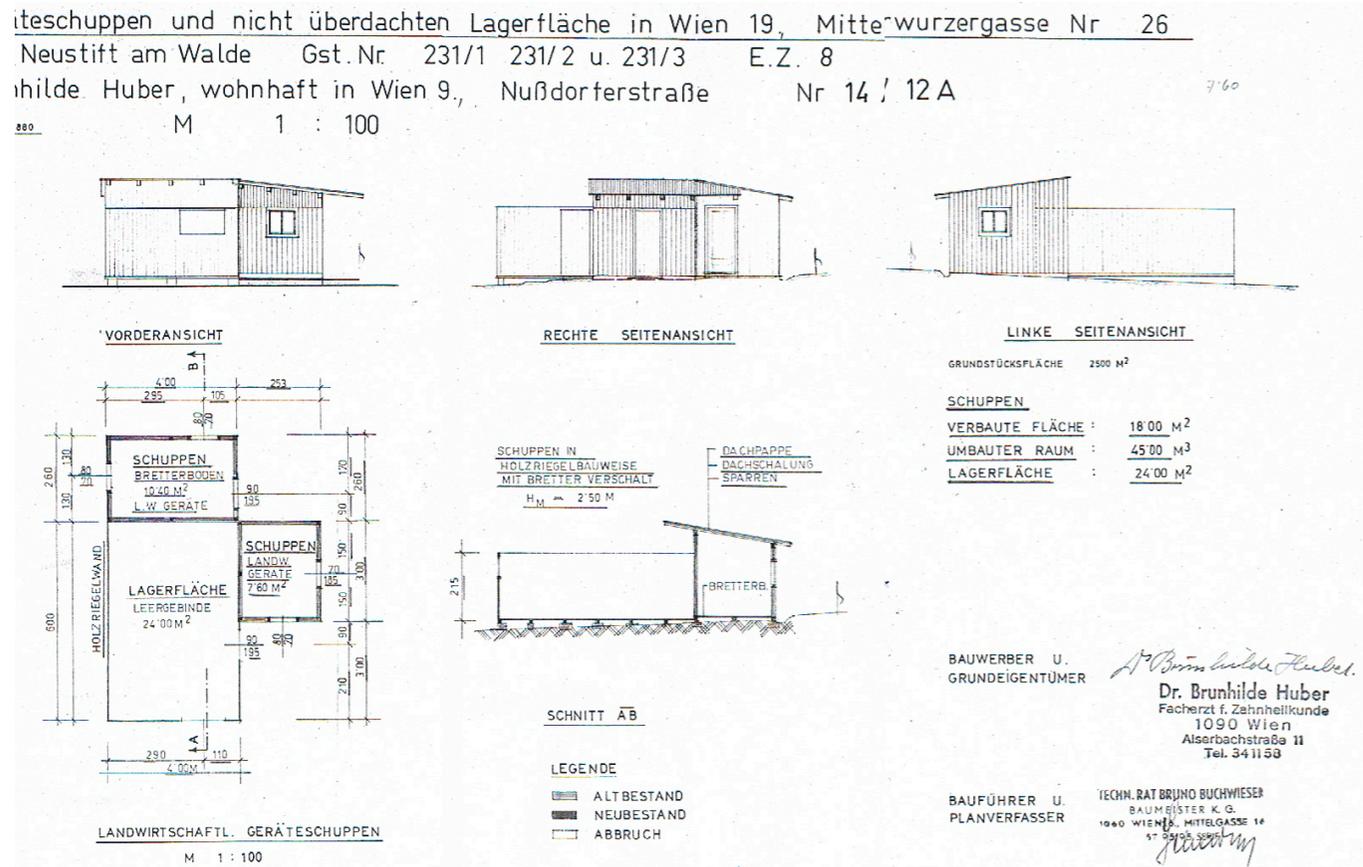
Schuppen, Ansichten, Grundriss, Schnitt
